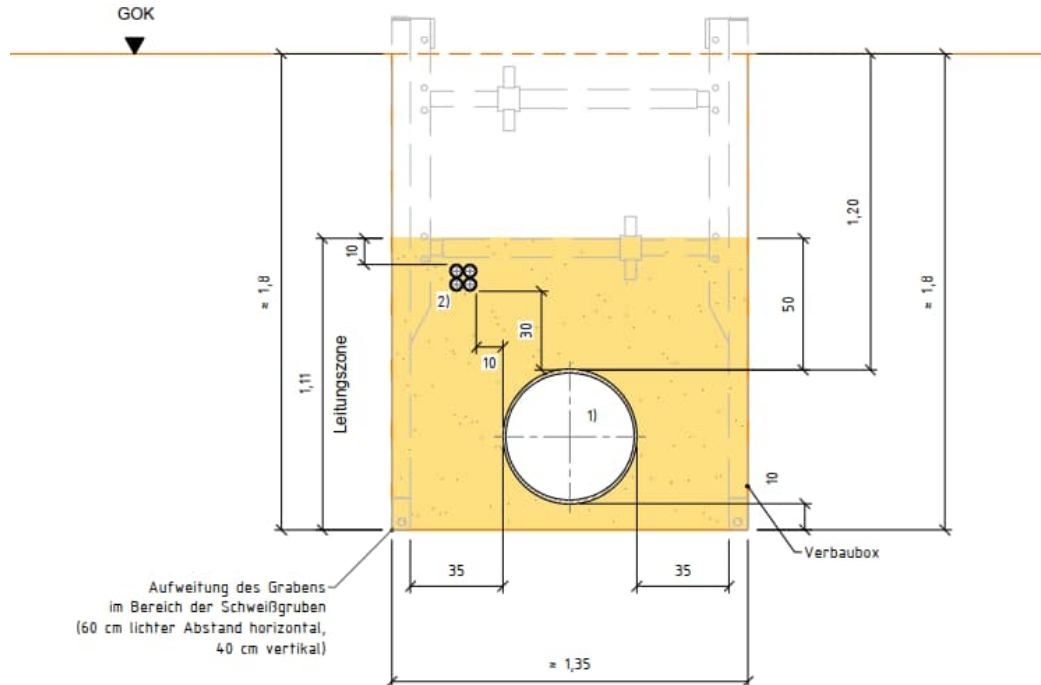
Auszug aus Regelquerschnitt - offene Bauweise, Detail Leitungsgaben [2.2]
